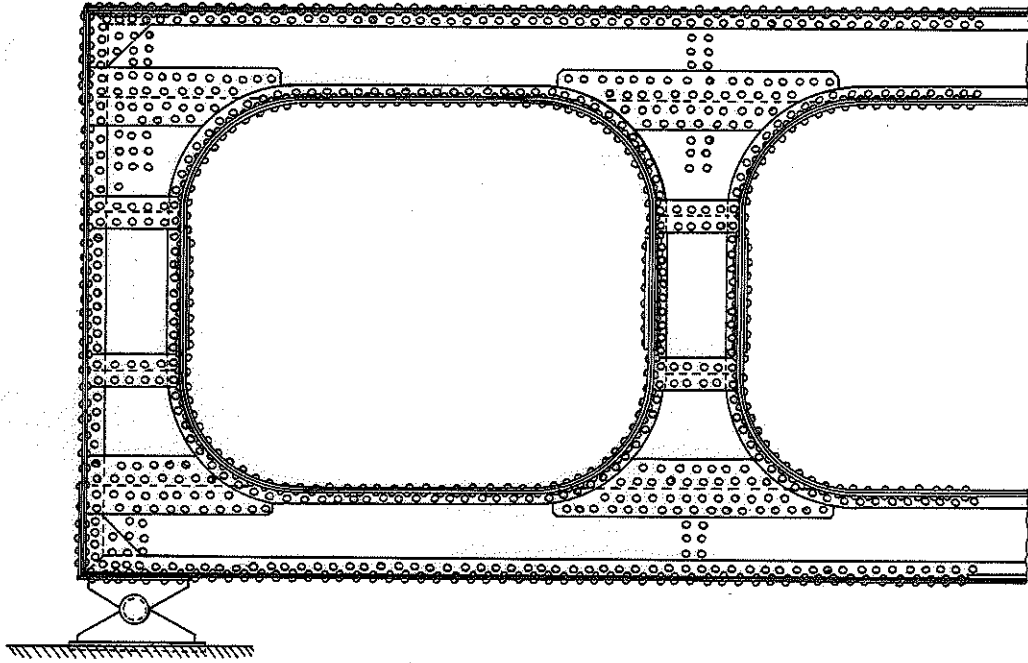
Primeiro Painel da Viga em Arcadas, Ensaída por Vierendeel em 1898.
